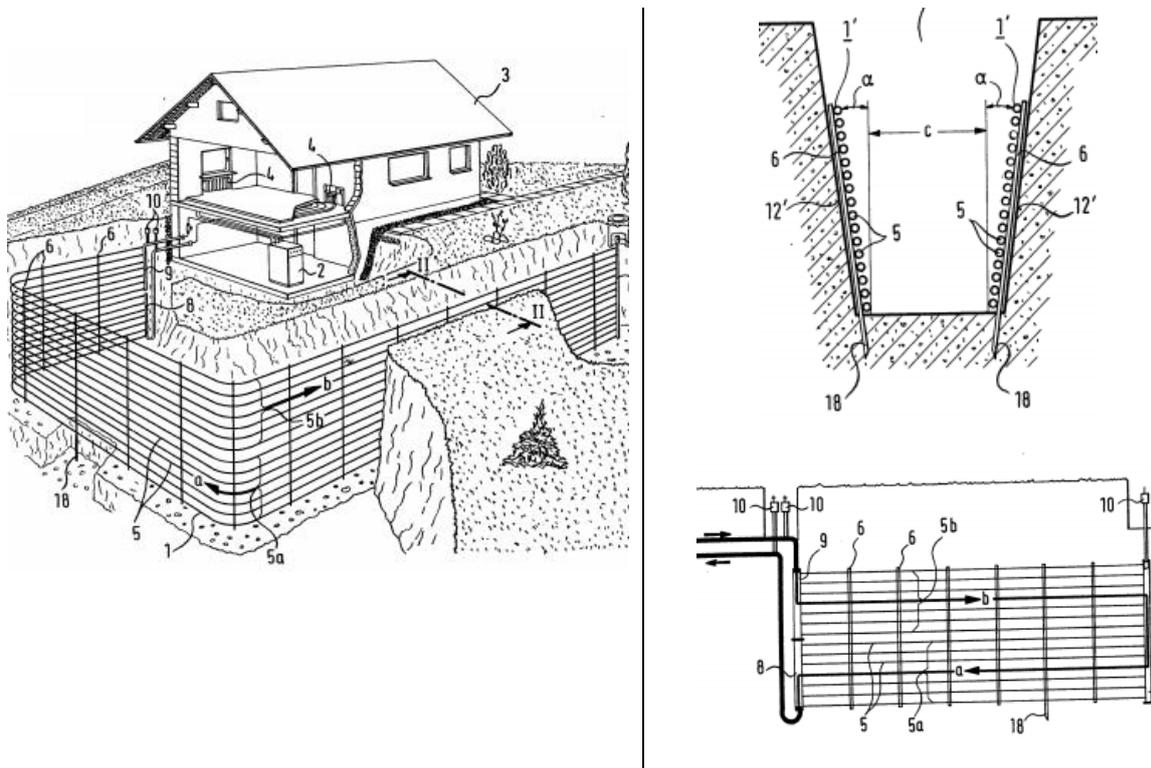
Ejemplo de una casa con el colector horizontal propuesto en la patente AT 378 260 B (izq.) y vistas detalladas de la disposición de los tubos en ese colector (der.)
